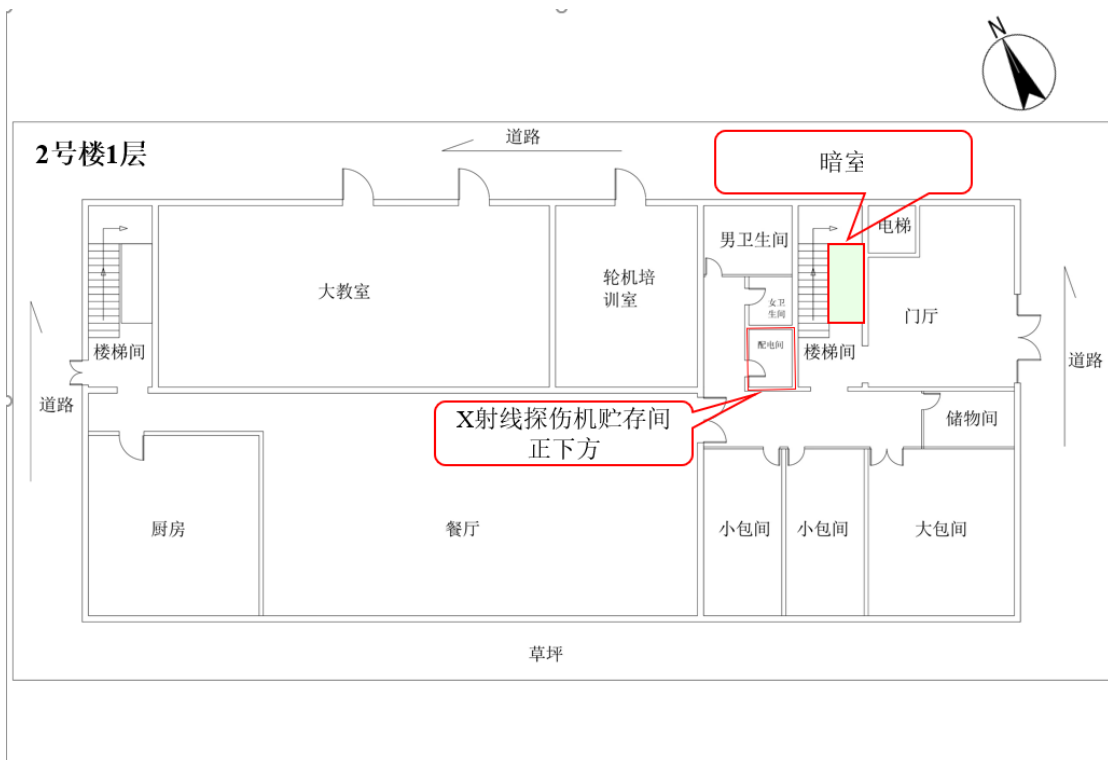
厂区 2 号楼 1 层平面布置示意图 (暗室位置)
